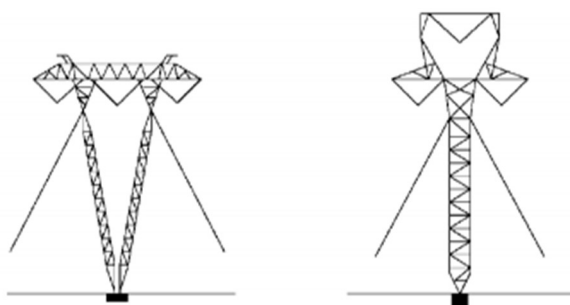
Exemplos de silhuetas de estruturas estaiadas [17]
